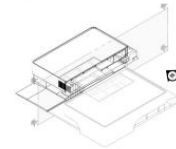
Denah lantai 2 (Sumber: Dok. Pribadi)
